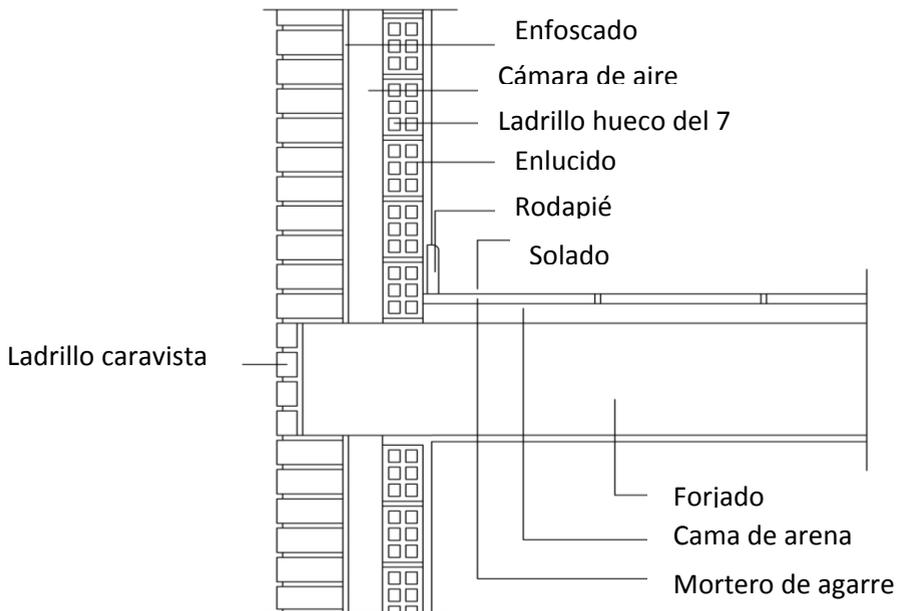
Detalle constructivo encuentro con forjado. Fuente propia 2014.
